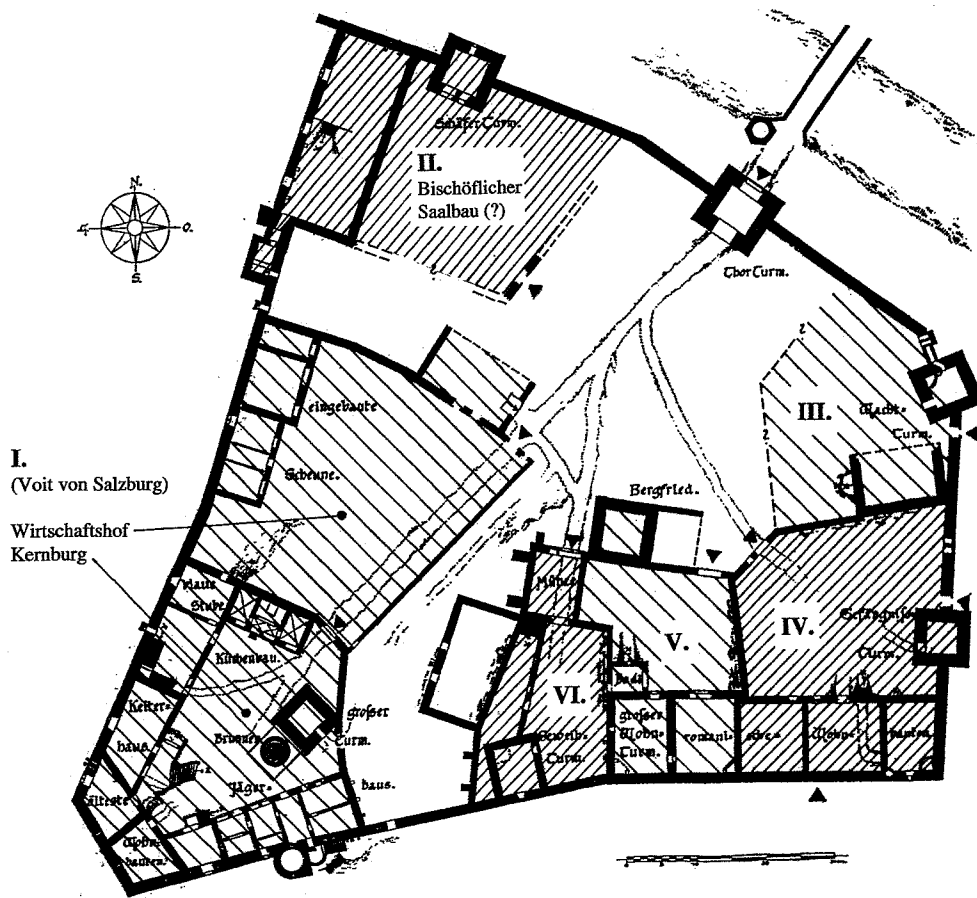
Salzburg in Unterfranken, Grundriss mit Rekonstruktionsversuch der Innenaufteilung und der Burgmannensitze (I - VI) im 13. Jahrhundert
